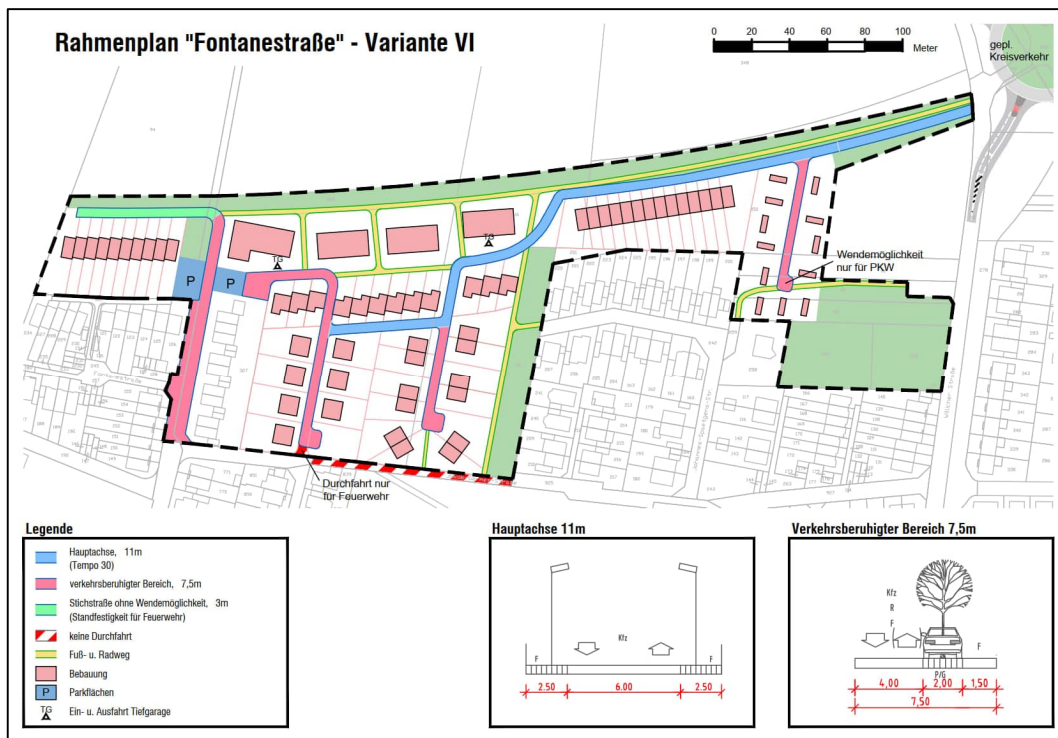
Rahmenplan „Fontanestraße“ – Variante VI [8]
